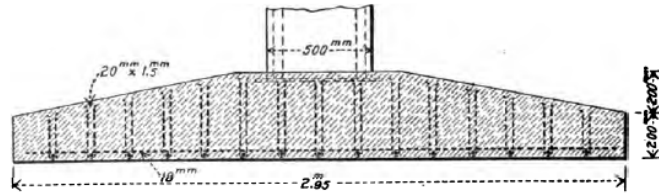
Zapata aislada con refuerzos. Buel [3].
